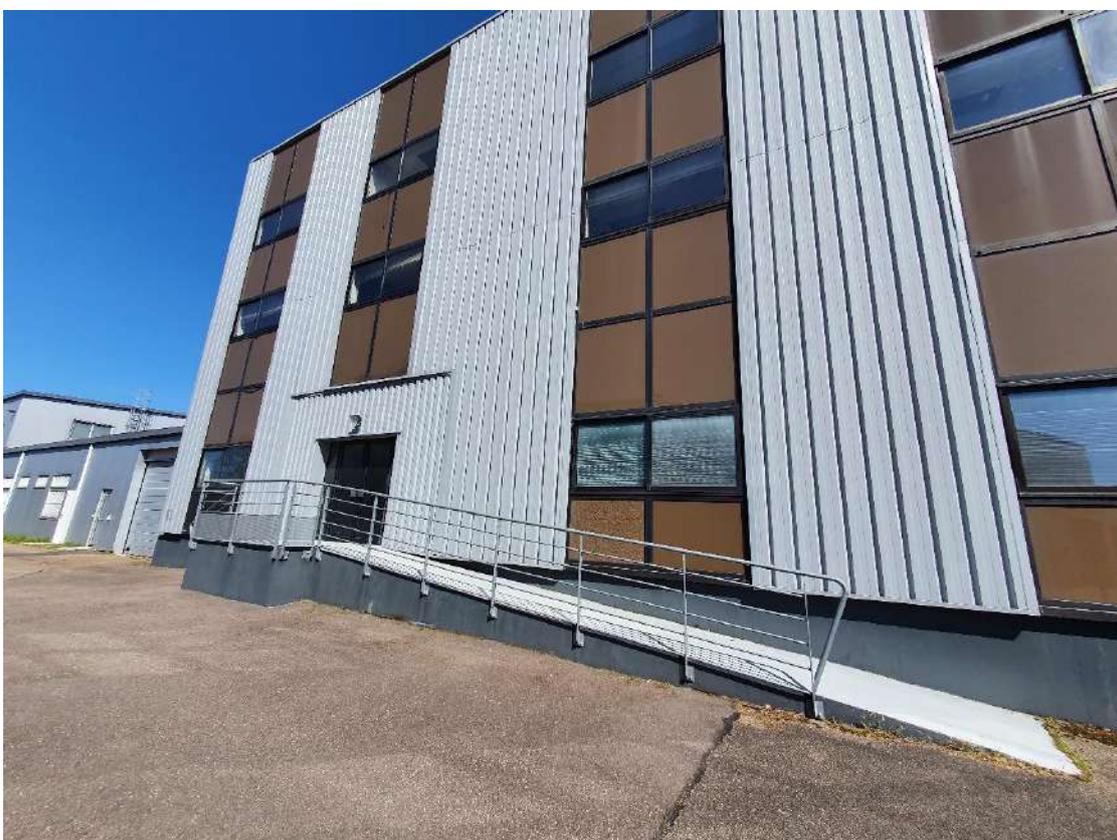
Lot 7 / Face OUEST / Accès piéton et rampe PMR
